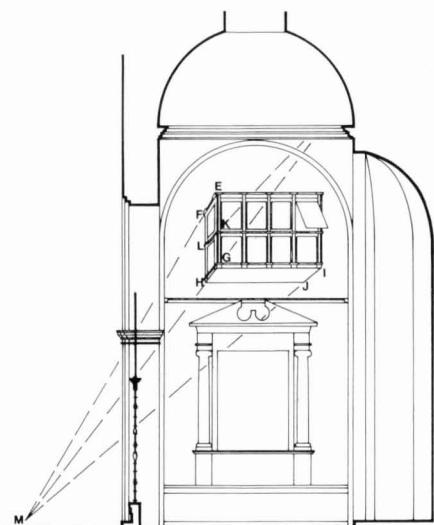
Calahorra, catedral. Sección de la capilla del Pilar y esquema lineal del falso balcón pintado en su muro izquierdo.
